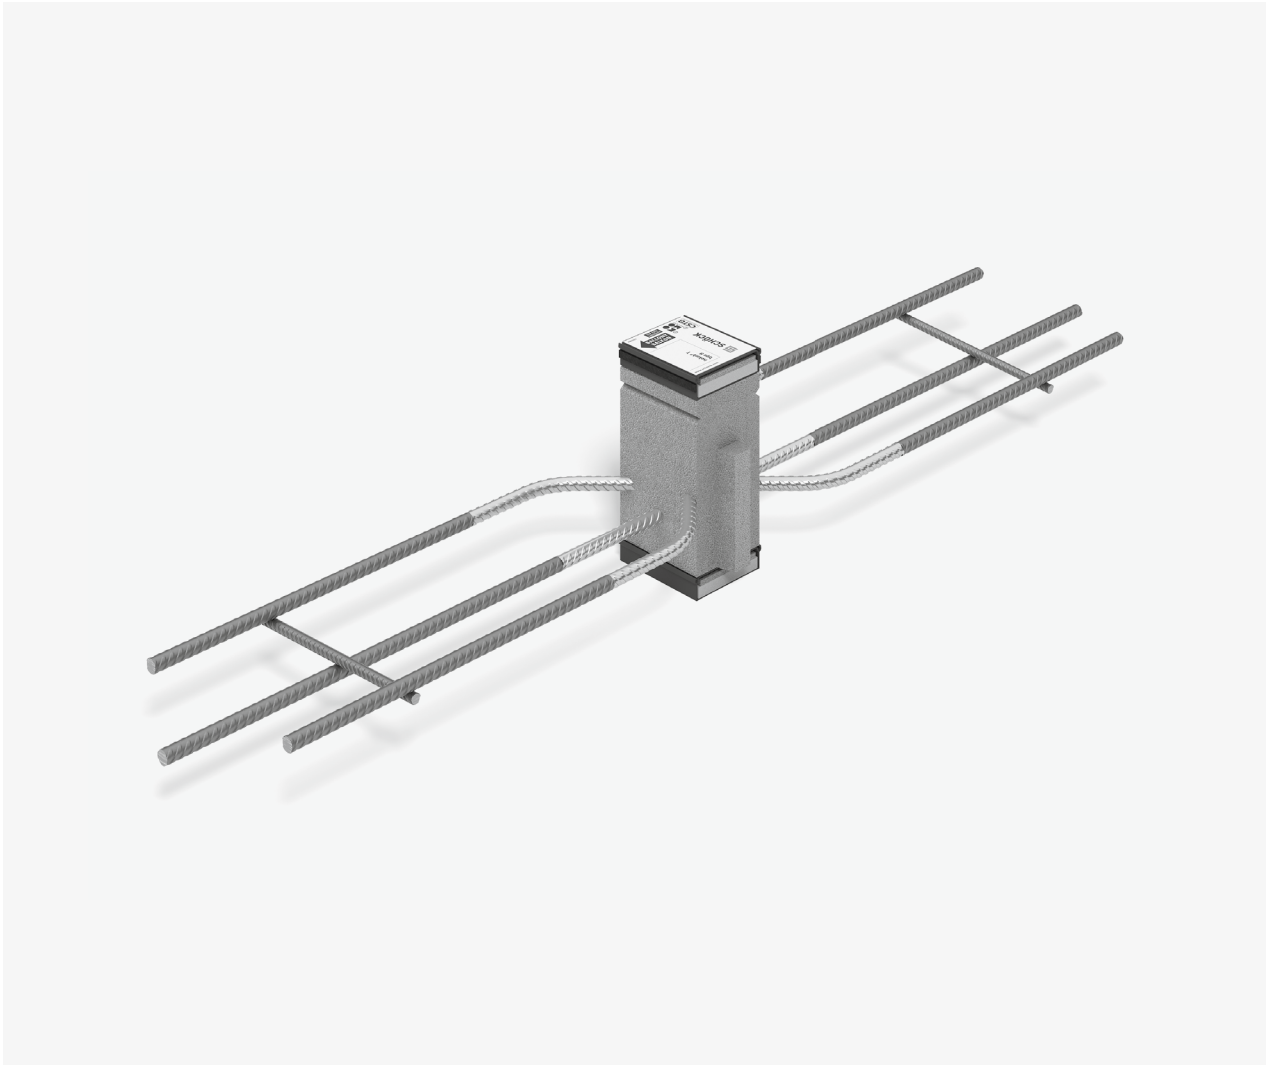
Schöck Isokorb® T Typ C-M3: Bauseitige Bewehrung (obere Lage)
